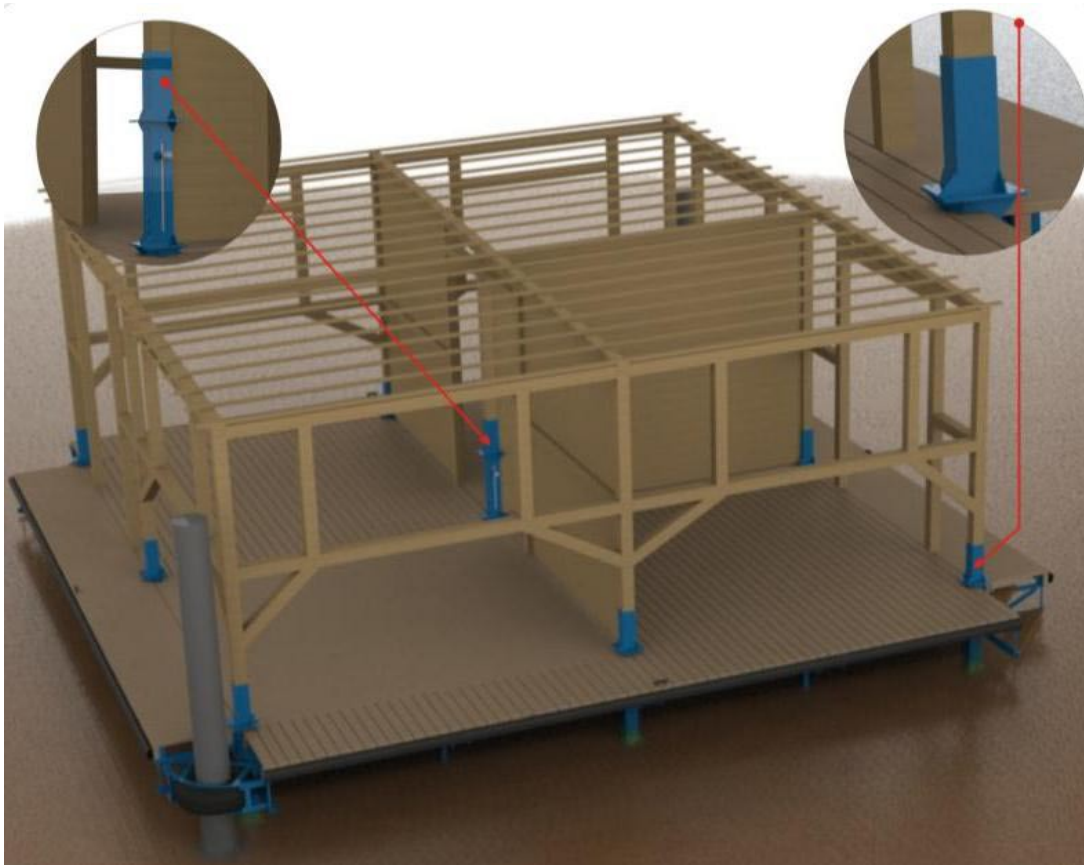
Sistema de fijación de la vivienda a la plataforma
